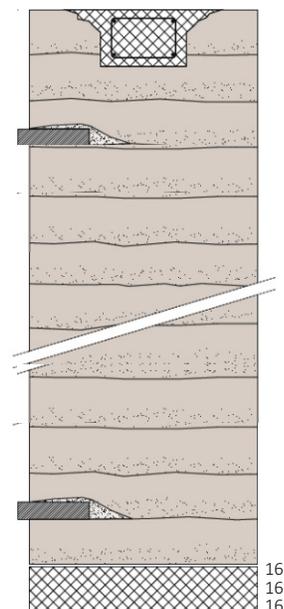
Haus Eigner 1969, umlaufende Betonschürze
